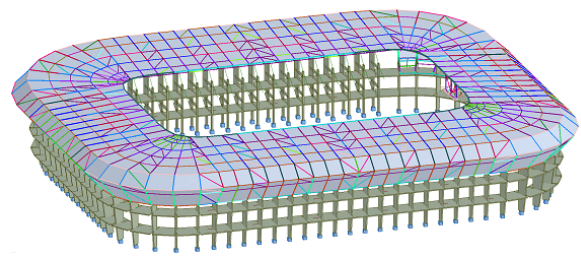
Modelo de cálculo de cubierta y estructura inferior de hormigón armado
